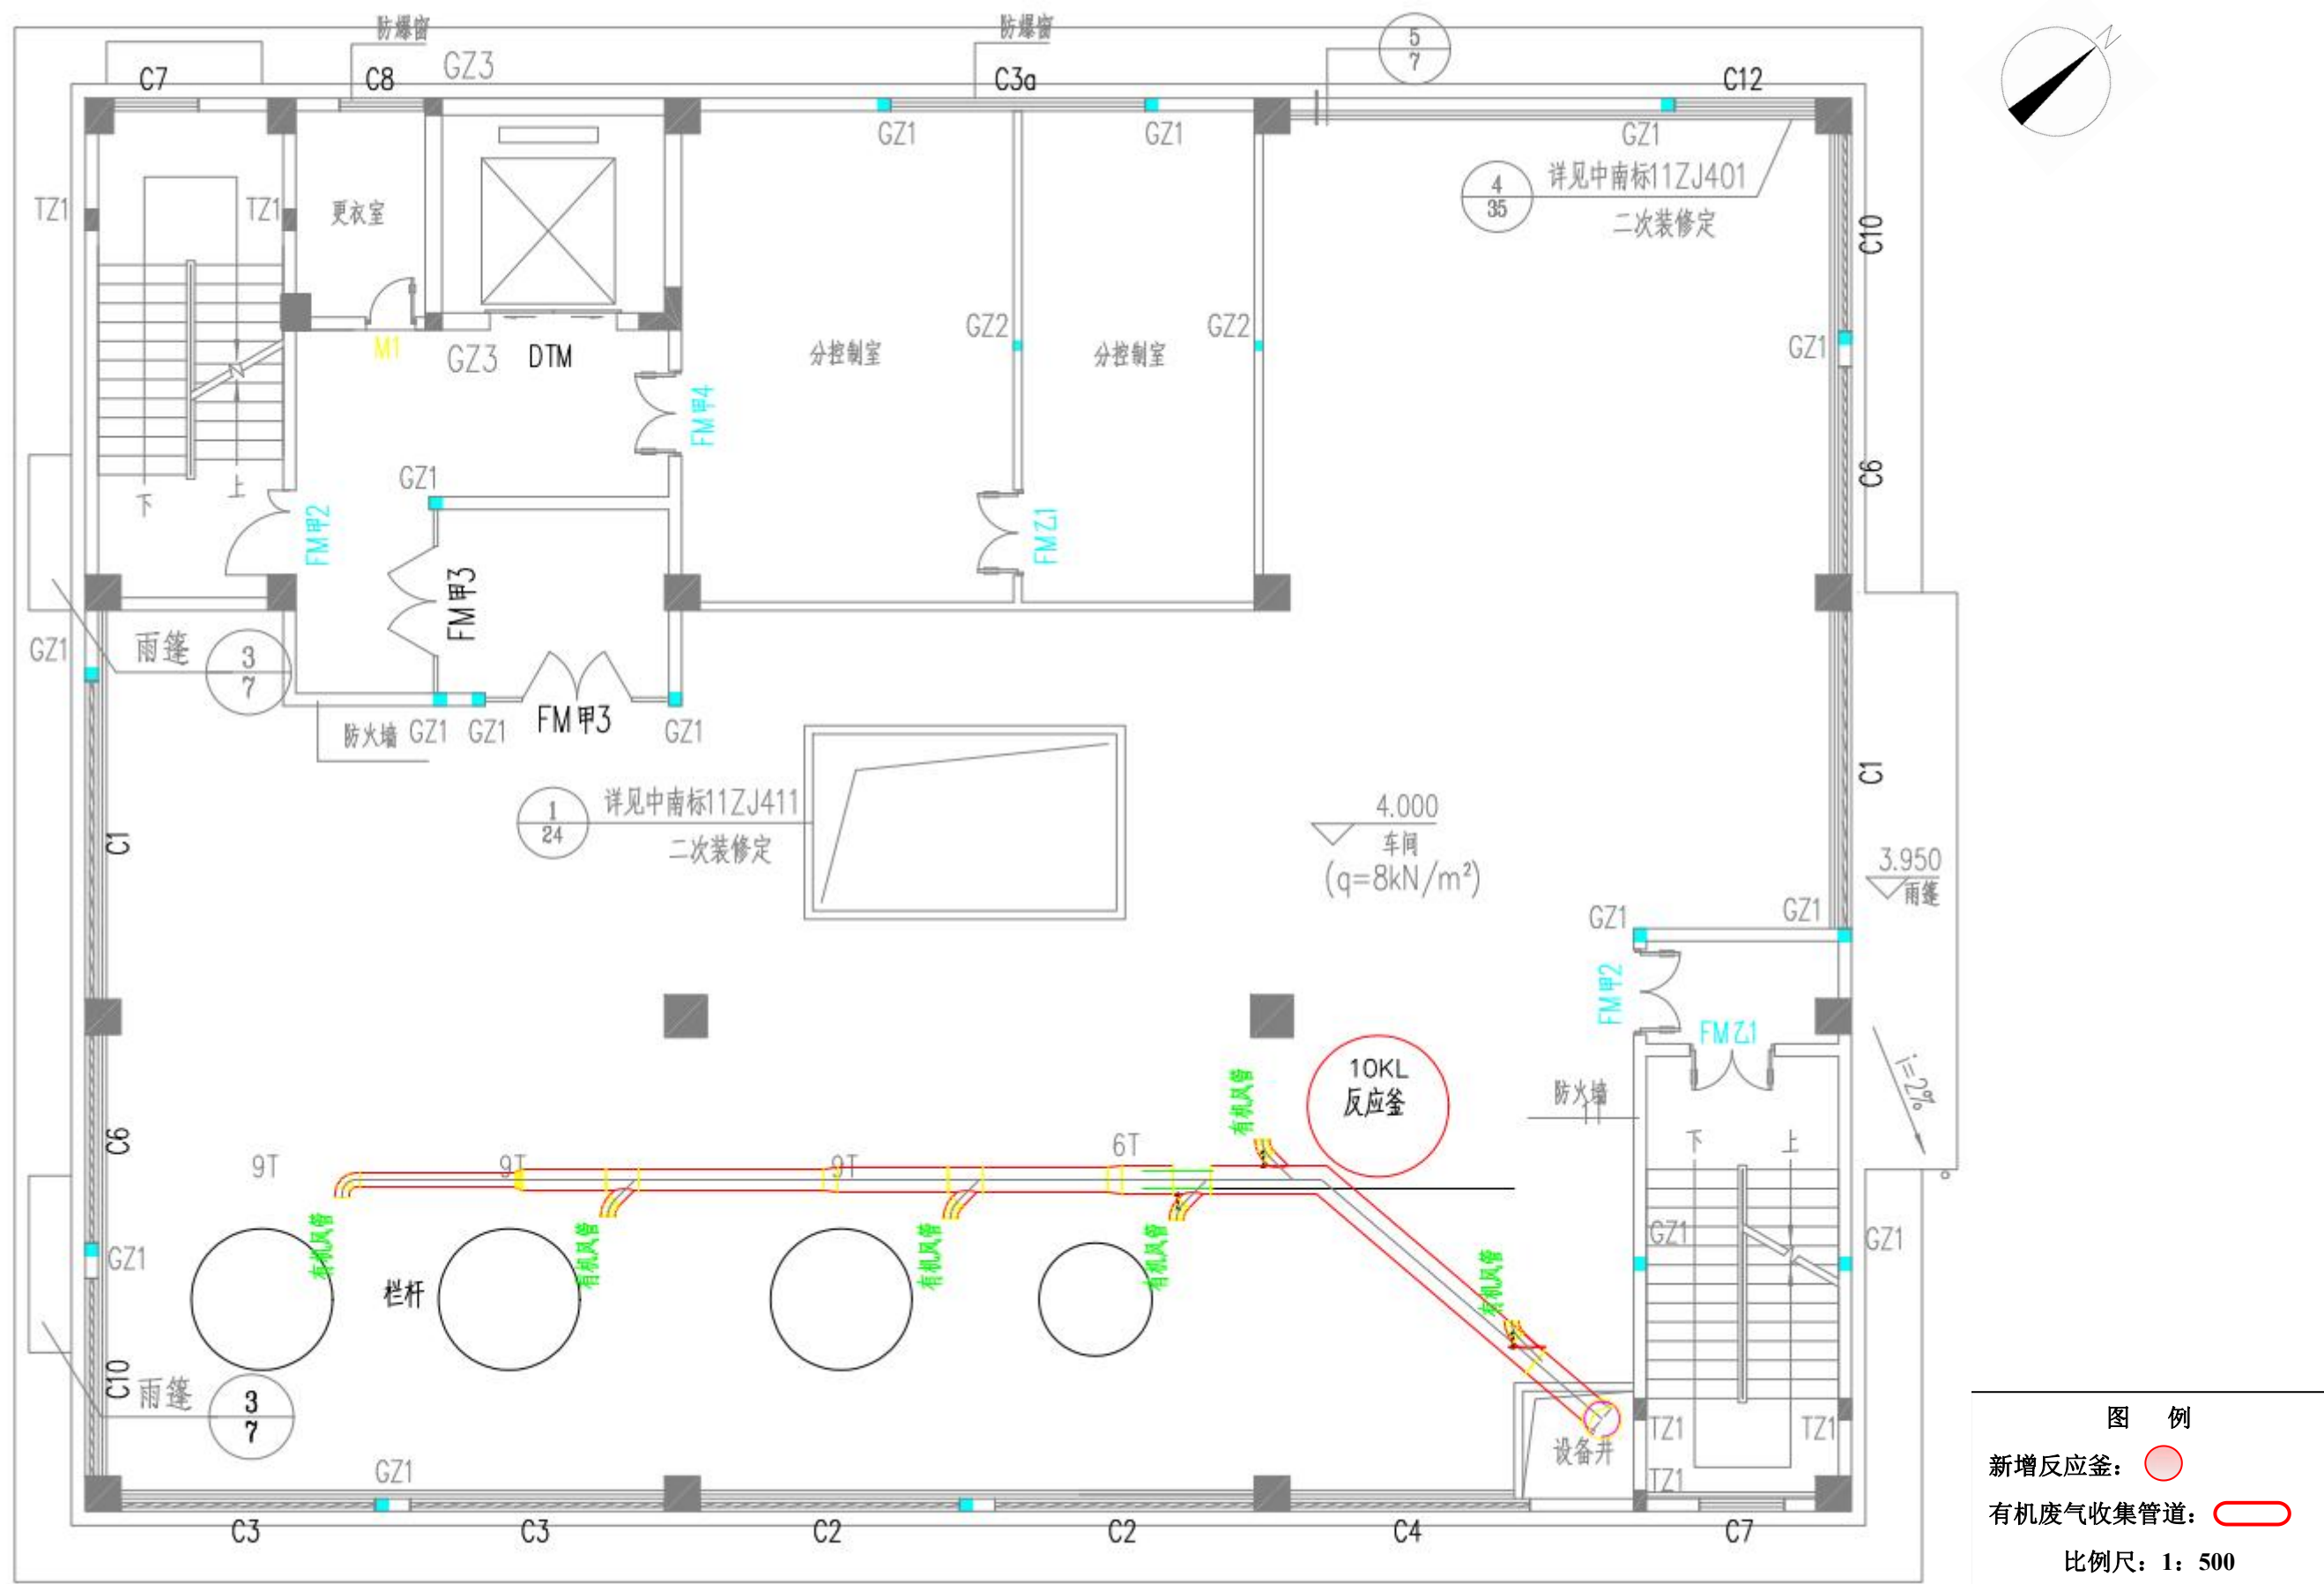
改扩建后, 树脂生产线 2F 平面布置图
